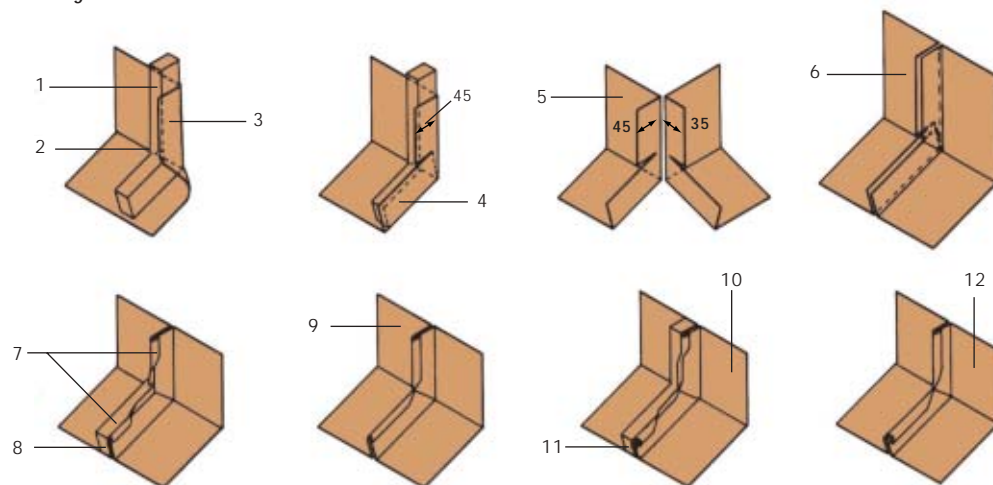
Detalhe sequencial das juntas elevadas da vertente com a parede - Processo construtivo.
